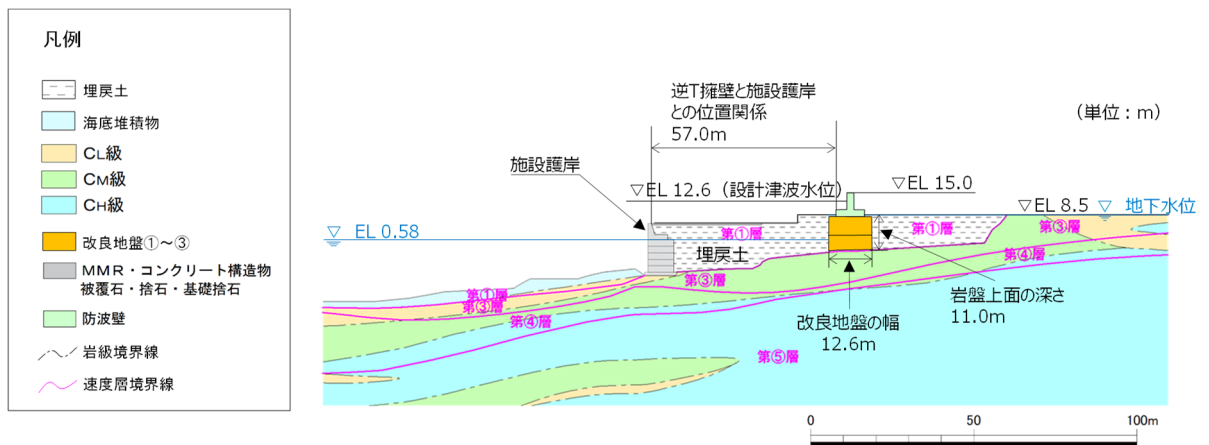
防波壁（逆 T 擁壁）の横断面図（⑥-⑥断面）
